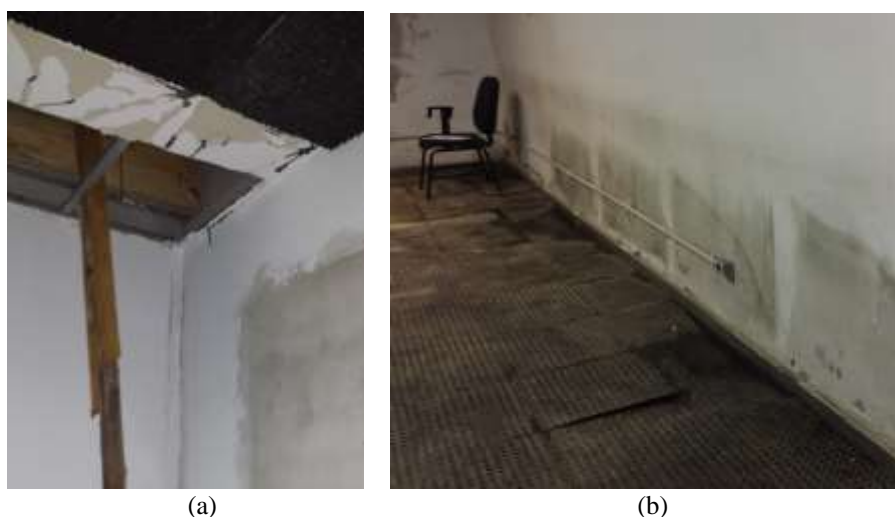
(a) Forro danificado - sala 203, (b) Manchamento na parede em drywall e piso descolado – sala 203.
